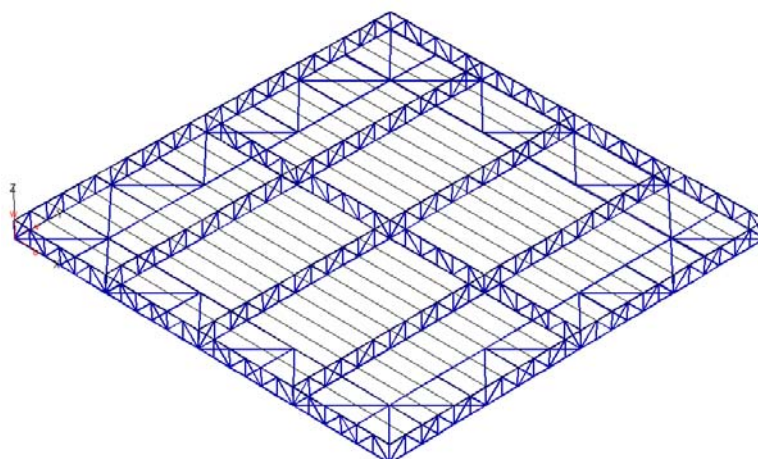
Односкатное покрытие здания с применением перекрестных легких ферм
